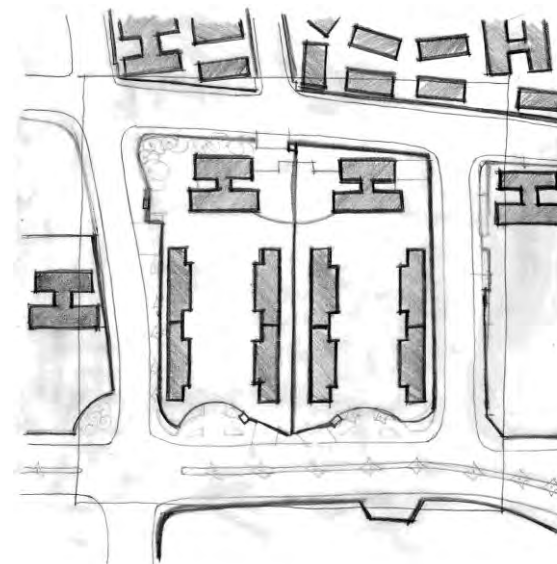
Diagrama tipo croqui em planta do recorte urbano do bairro Jardim Europa em Porto Alegre
